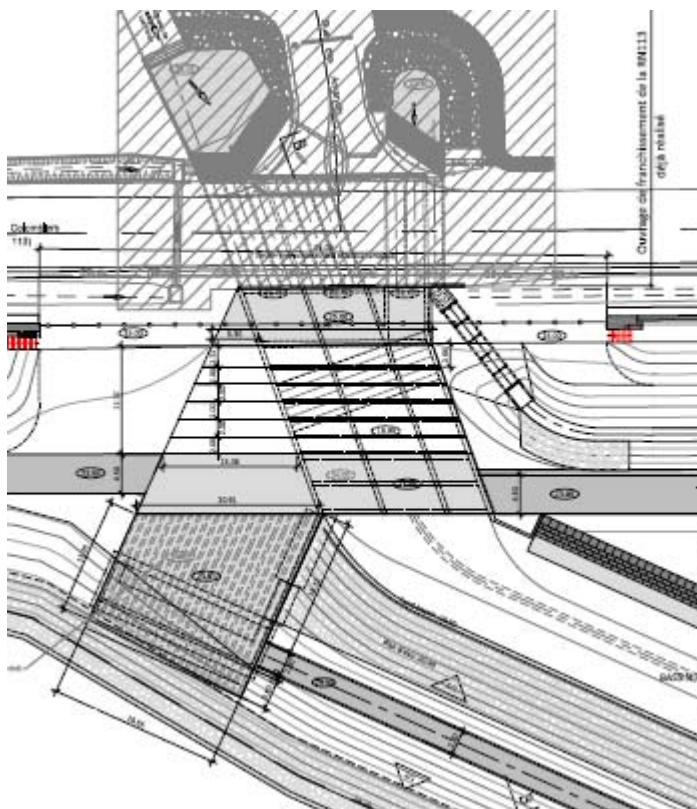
Vue en plan de l'ouvrage d'entonnement amont
